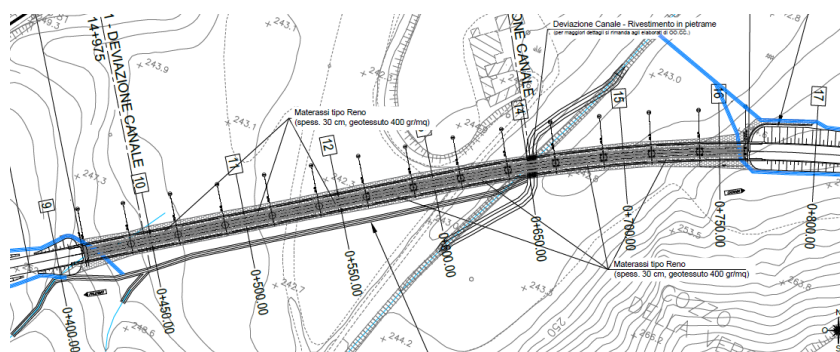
Viadotto VI01: stralcio della planimetria delle opere di sistemazione idraulica.
